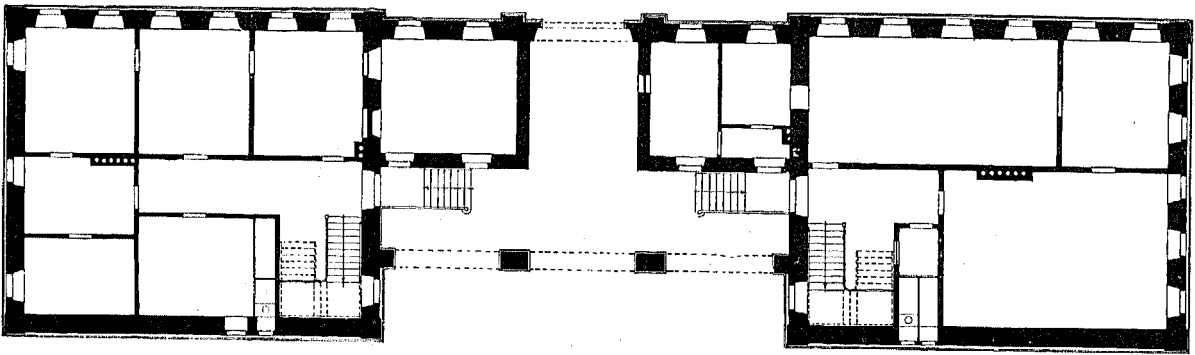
Sand-Hof; Grundriss des Erdgeschosses des Hauptbaues. 1:300.
